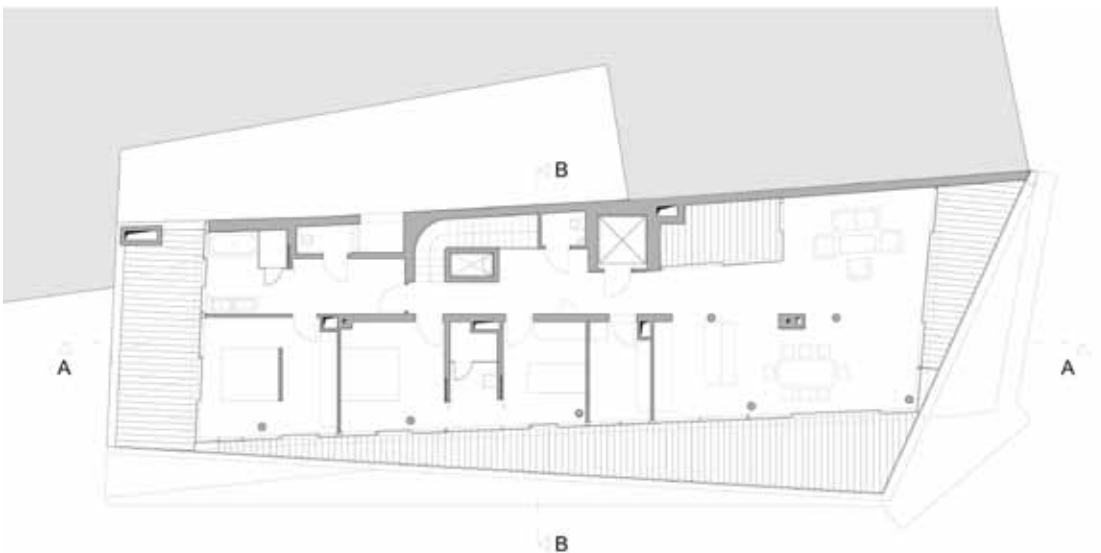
Grundriss 3.DG © Josef Weicheberger Architects
